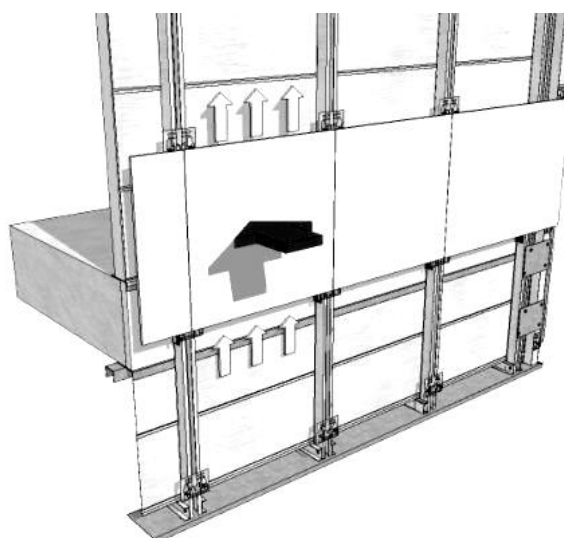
Aplicação de estruturas a seco, betão GRC
